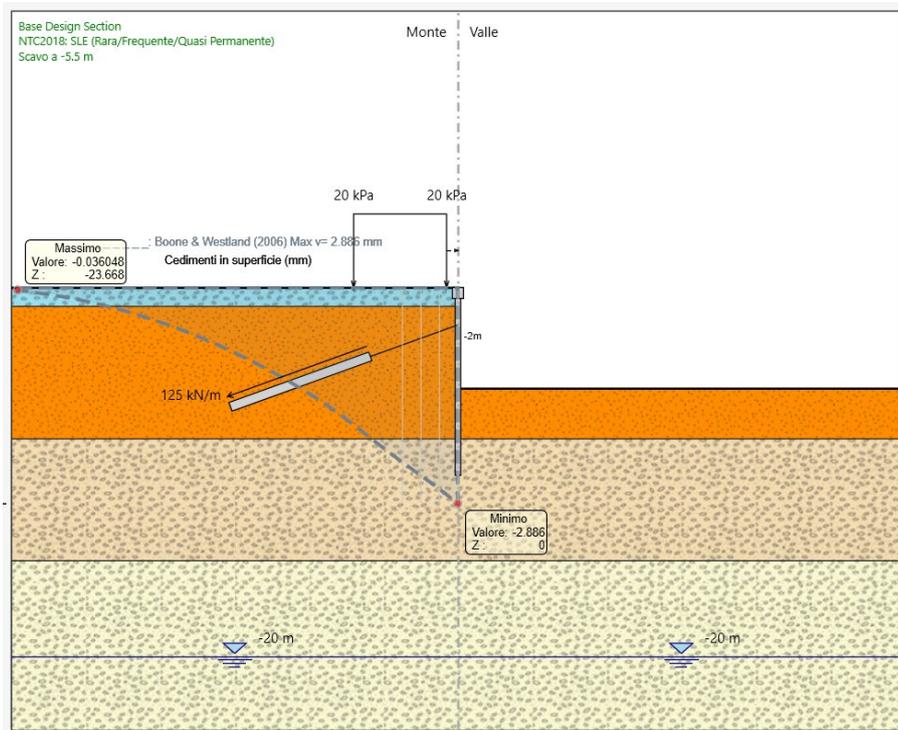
Sezione Tipo B – Spostamenti stima cedimenti
